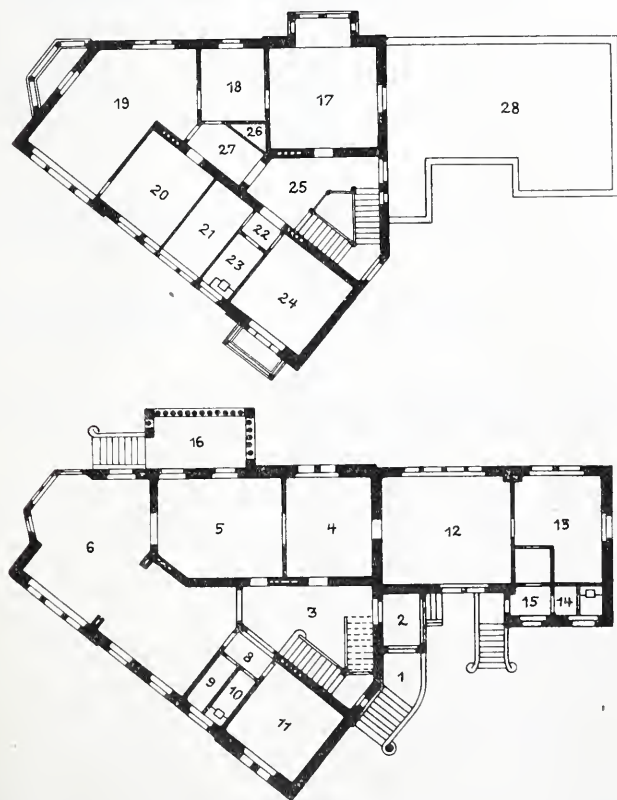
Grundrisse vom Erdgeschoss und vom I. Stock.
